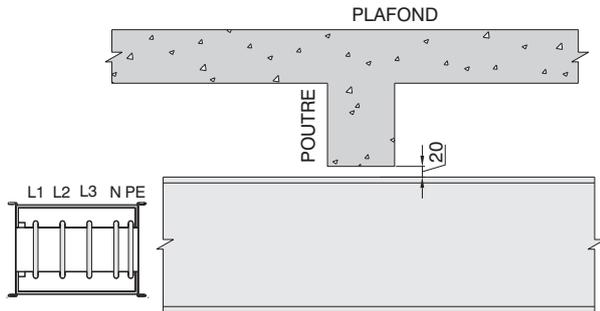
CROISEMENT D'UNE POUTRE EN POSITION VERTICALE
